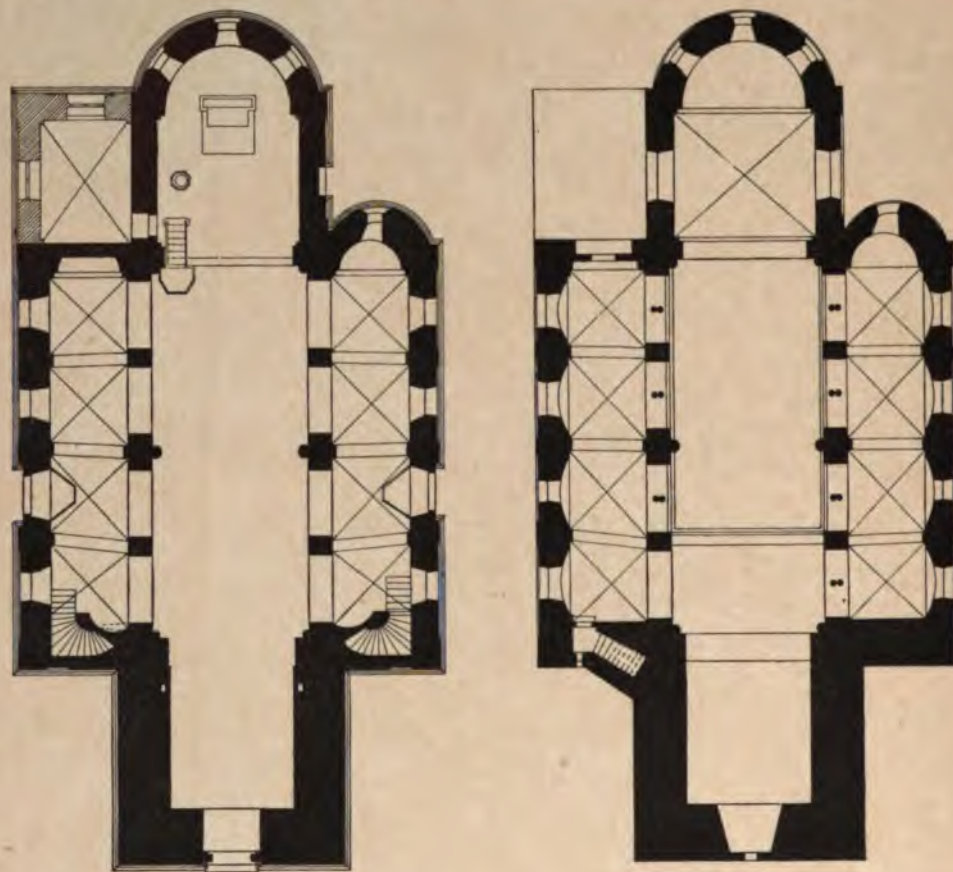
Hilden. Grundrisse der evangel. Pfarrkirche.
